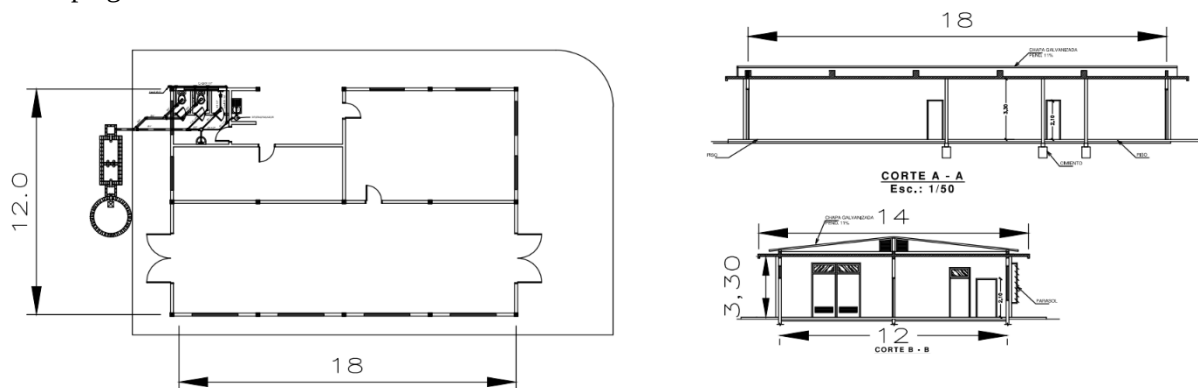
Planta y cortes longitudinal y transversal del RM
